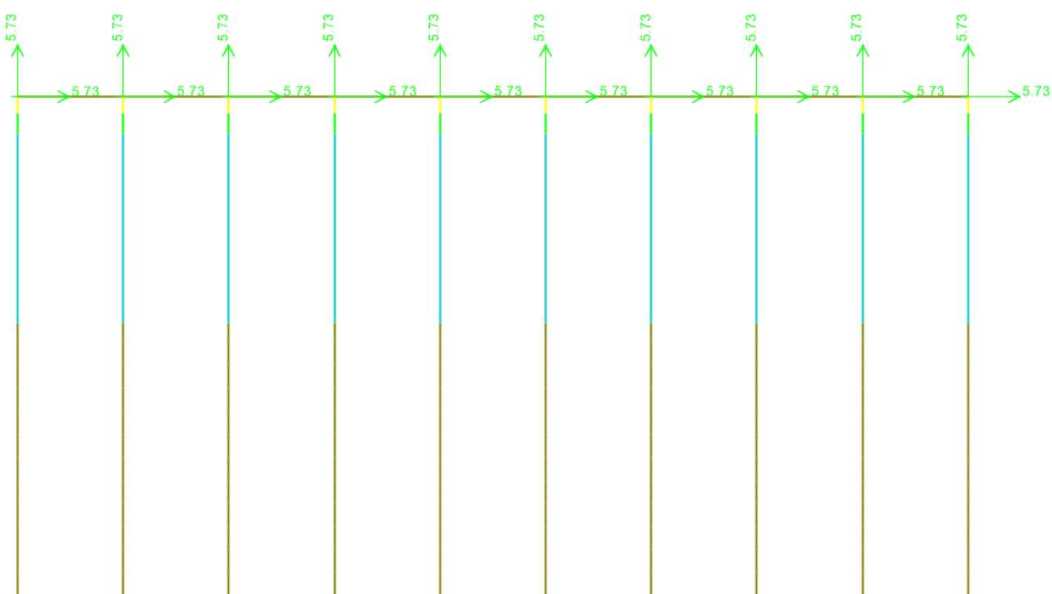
Joint Masses de pilotes verticales - Eje C (5.72 kN-s²/m)
